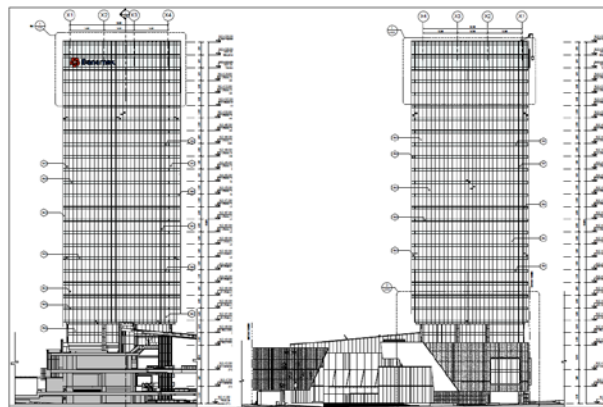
COLONNIER Y ASOCIADOS, Alzado general, 2014, Plano.
